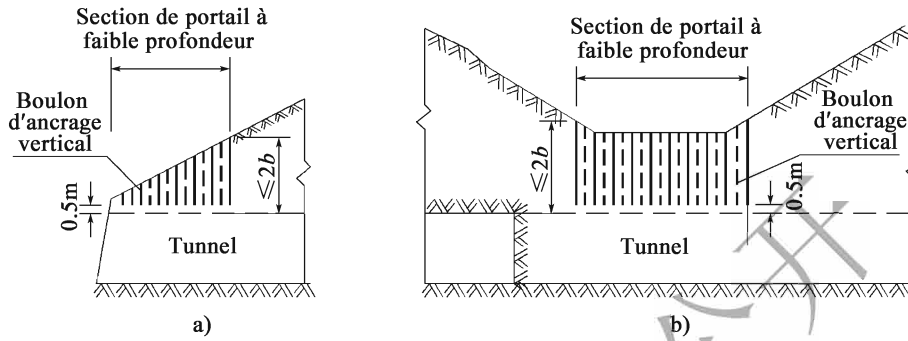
Disposition longitudinale du boulon scellé par le mortier sur le terrain de surface
